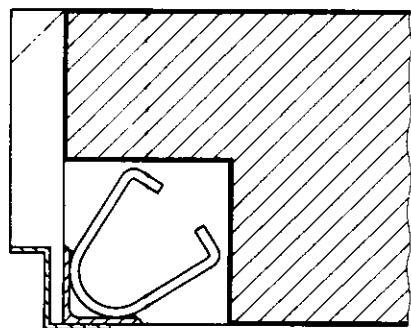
Anschweißanker, Einbaubeispiel (Grundriß)
